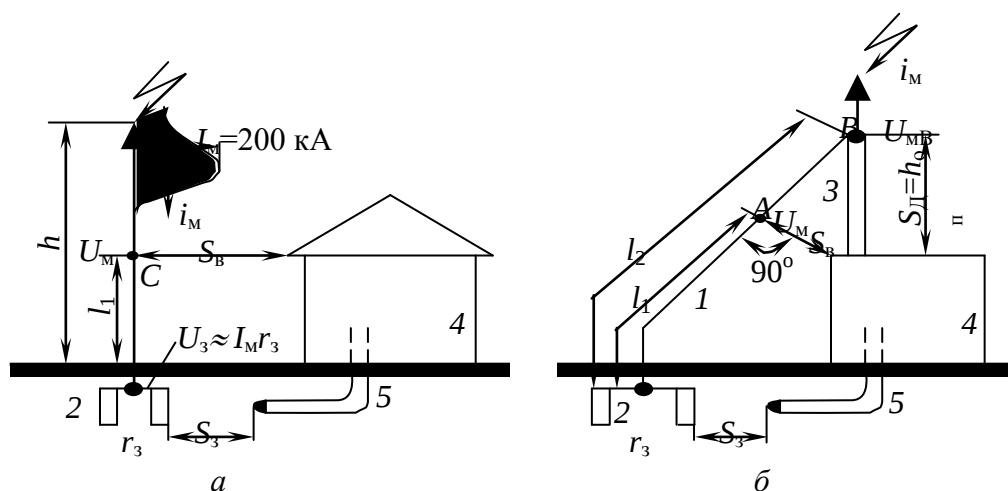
Расчетная схема определения безопасных расстояний от отдельно стоящего стержневого молниеотвода до сооружения:
